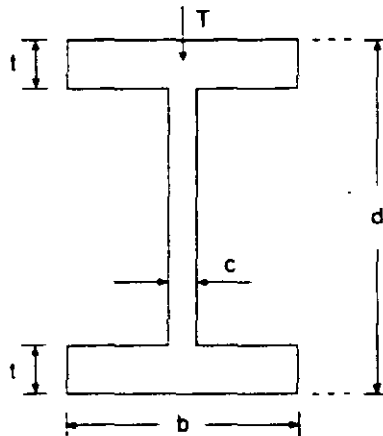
Dimensiones de la sección transversal de una viga I.
